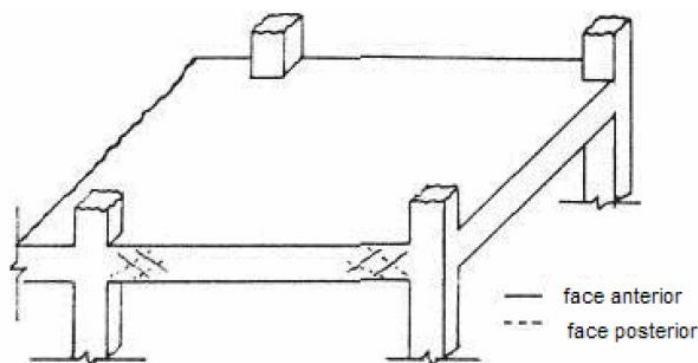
Fissuração típica de uma viga de betão armado sujeita a esforços de torção [1]
